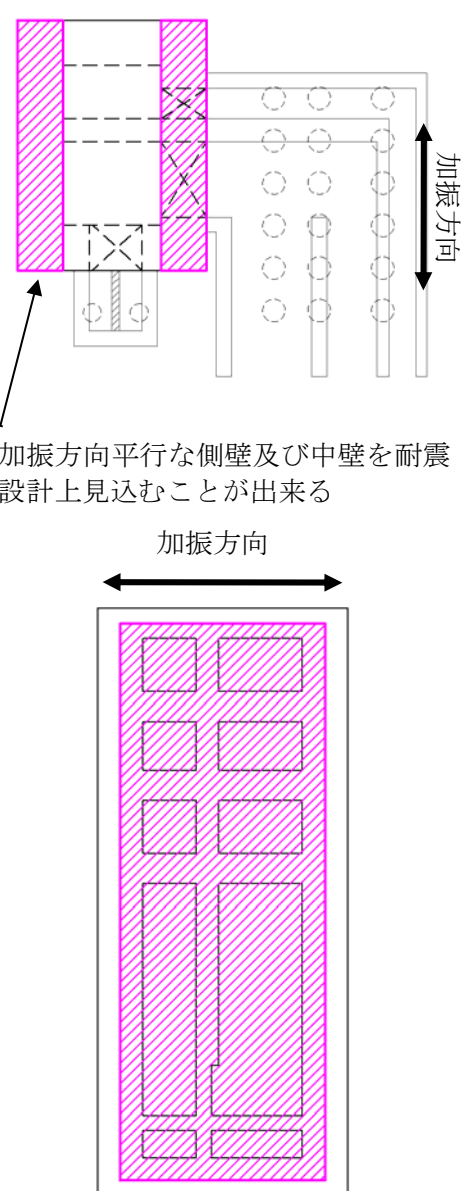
(2) 立坑の平面配置図（拡大図）
